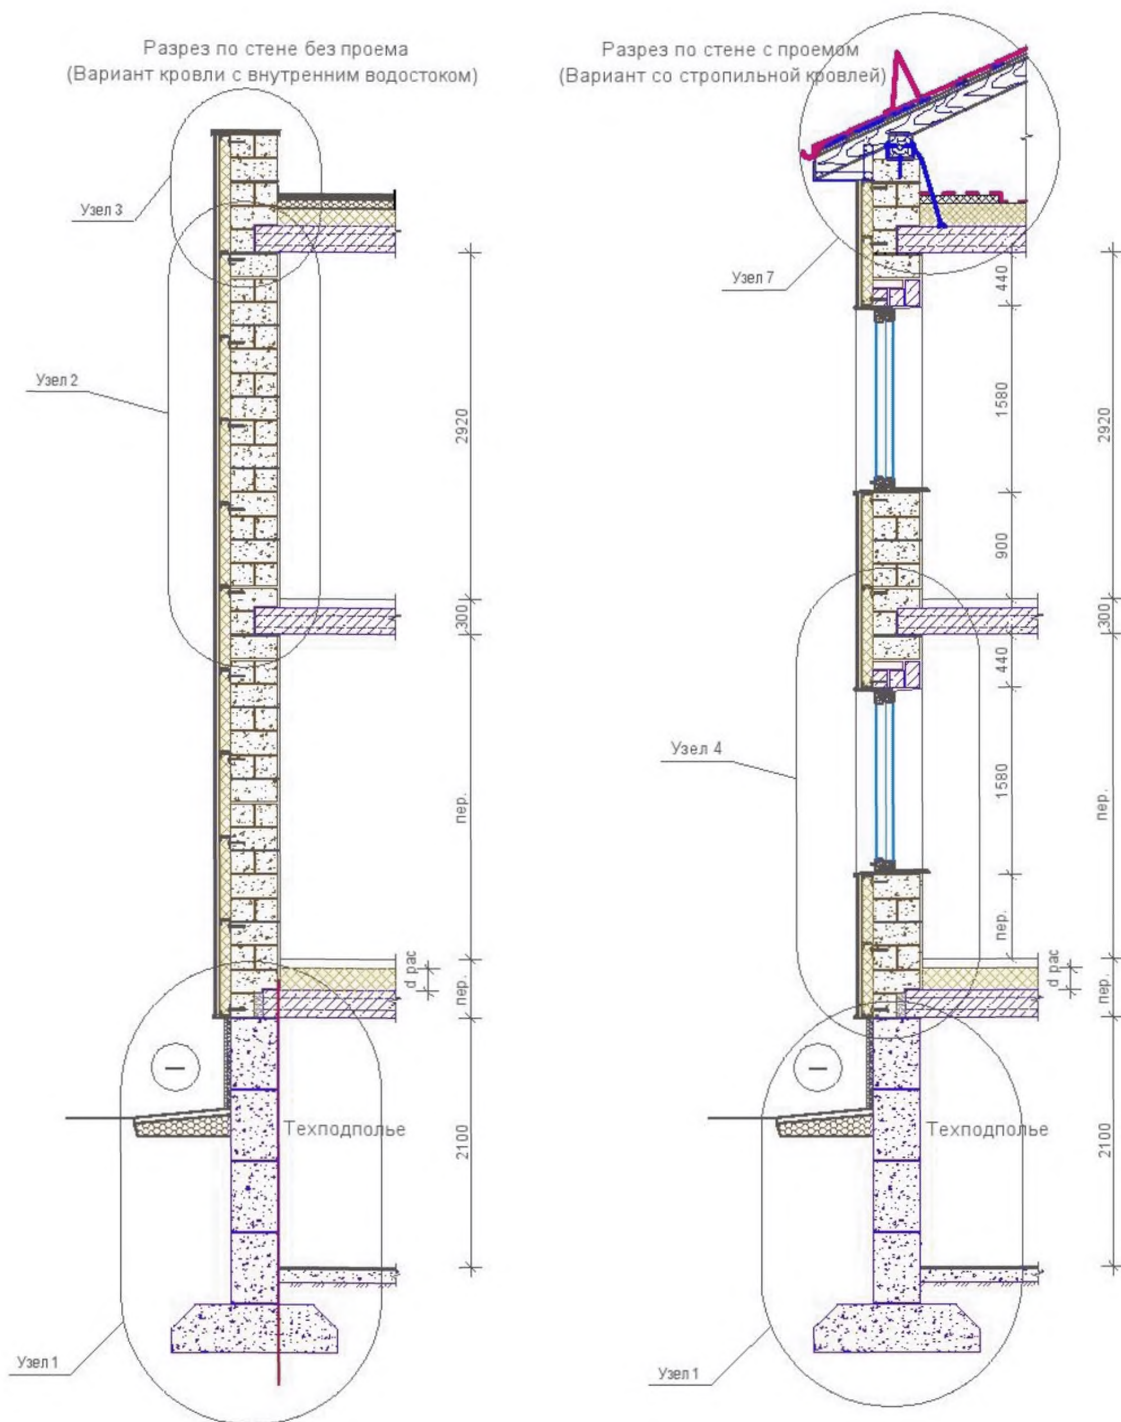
Схема нумерации узлов на поперечном разрезе здания
